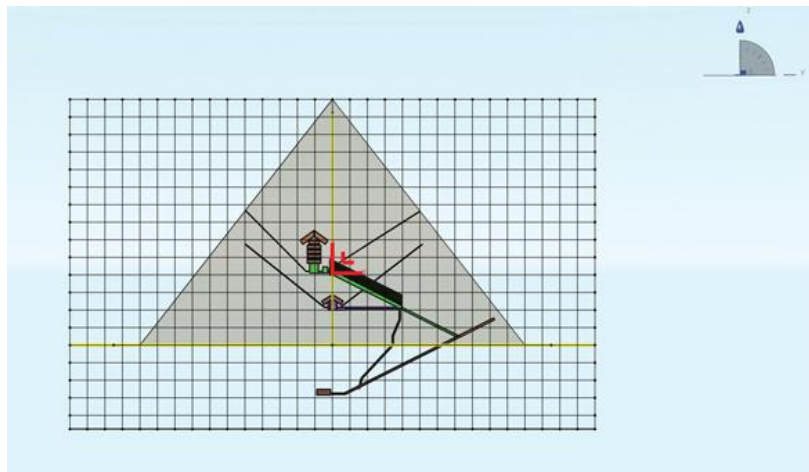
Conception à partir d'une grille sur un plan vertical (Houdin J-P, Dassault Systèmes)
